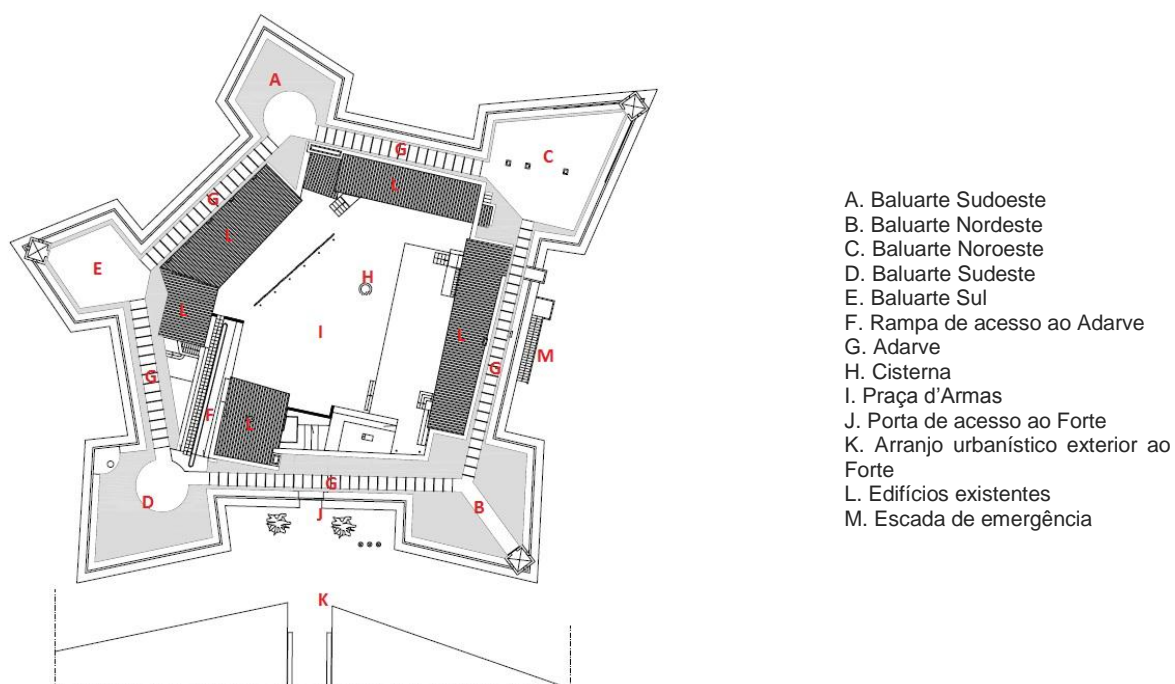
Configuração do Forte de S. João Baptista – Planta de cobertura.
